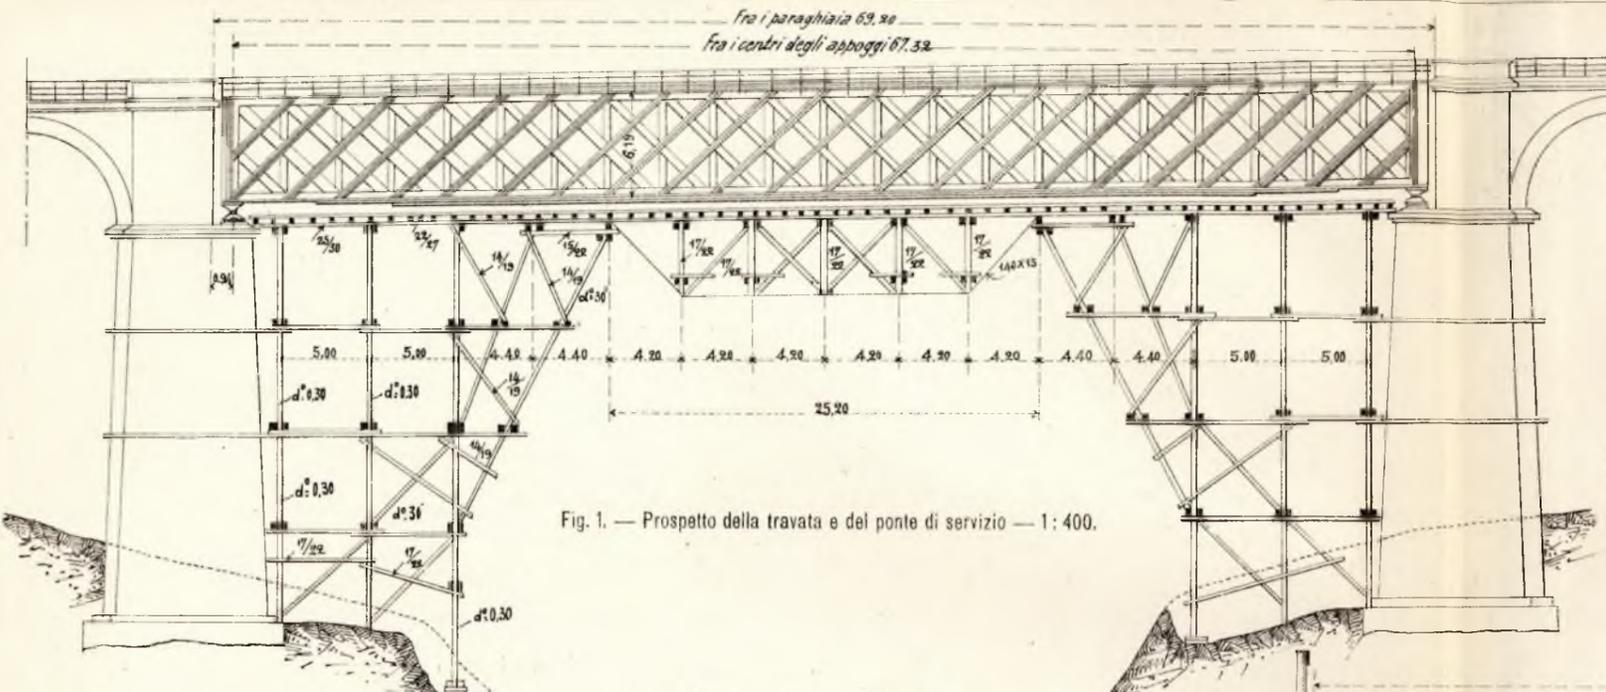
Prospetto della travata e del ponte di servizio — 1: 400.
